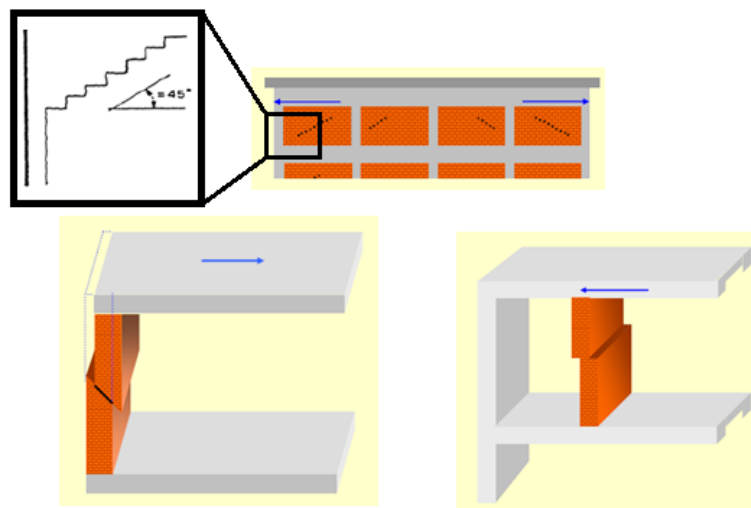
Fissuração em paredes inseridas em estruturas de betão armado
